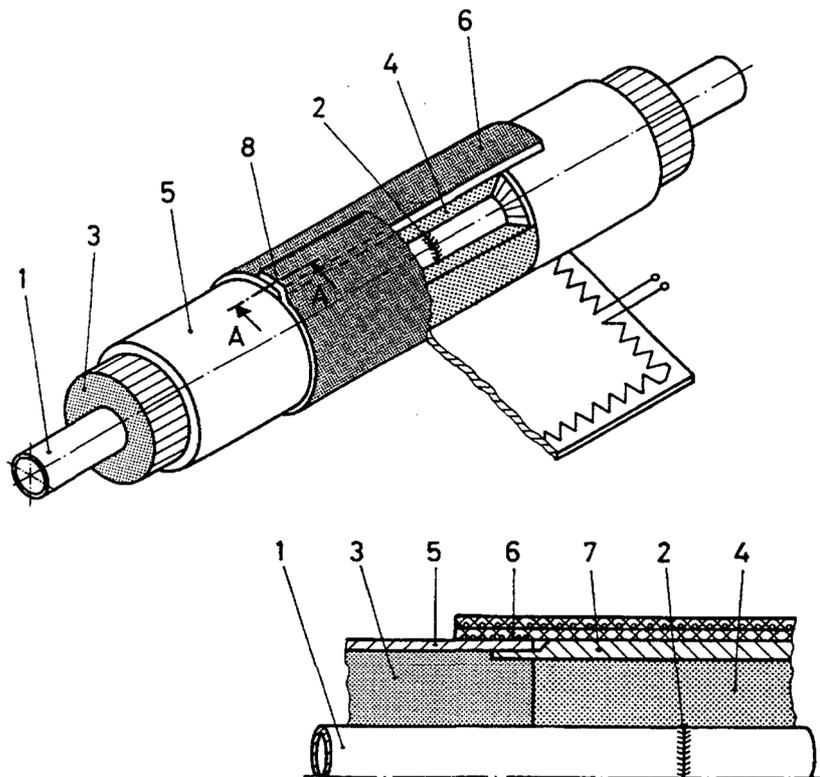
Конструкция клеевого стыкового соединения с термоусаживаемой муфтой. 1 – стальная труба; 2 – сварной стык; 3 – полиэтиленовая оболочка; 4 – провод СОДК; 5 – муфта; 6 – пенополиуретан; 7 – герметик; 8 – пробки; 9 – манжеты термоусаживаемые. В варианте РЕ-Х(с) манжета необязательна.
